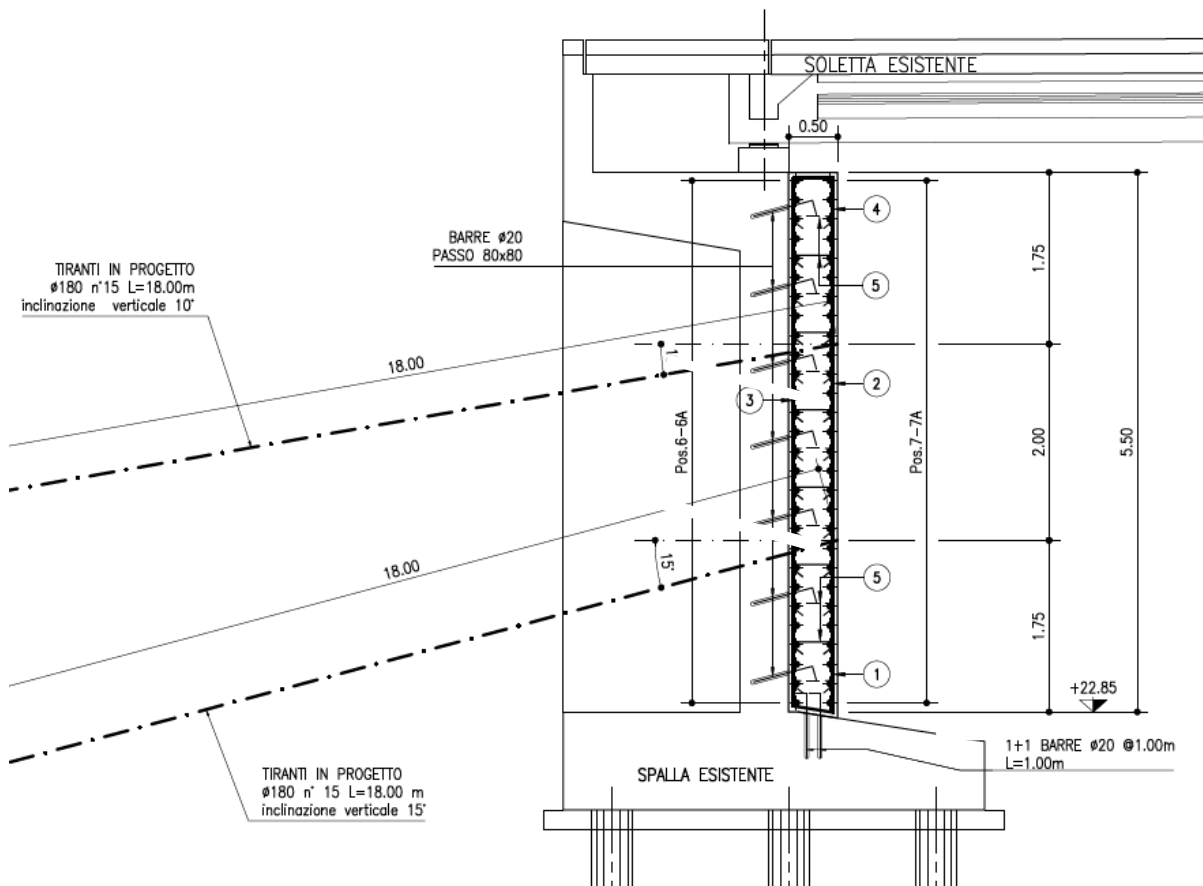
Spalle – Sezione tipo rinforzo strutturale
